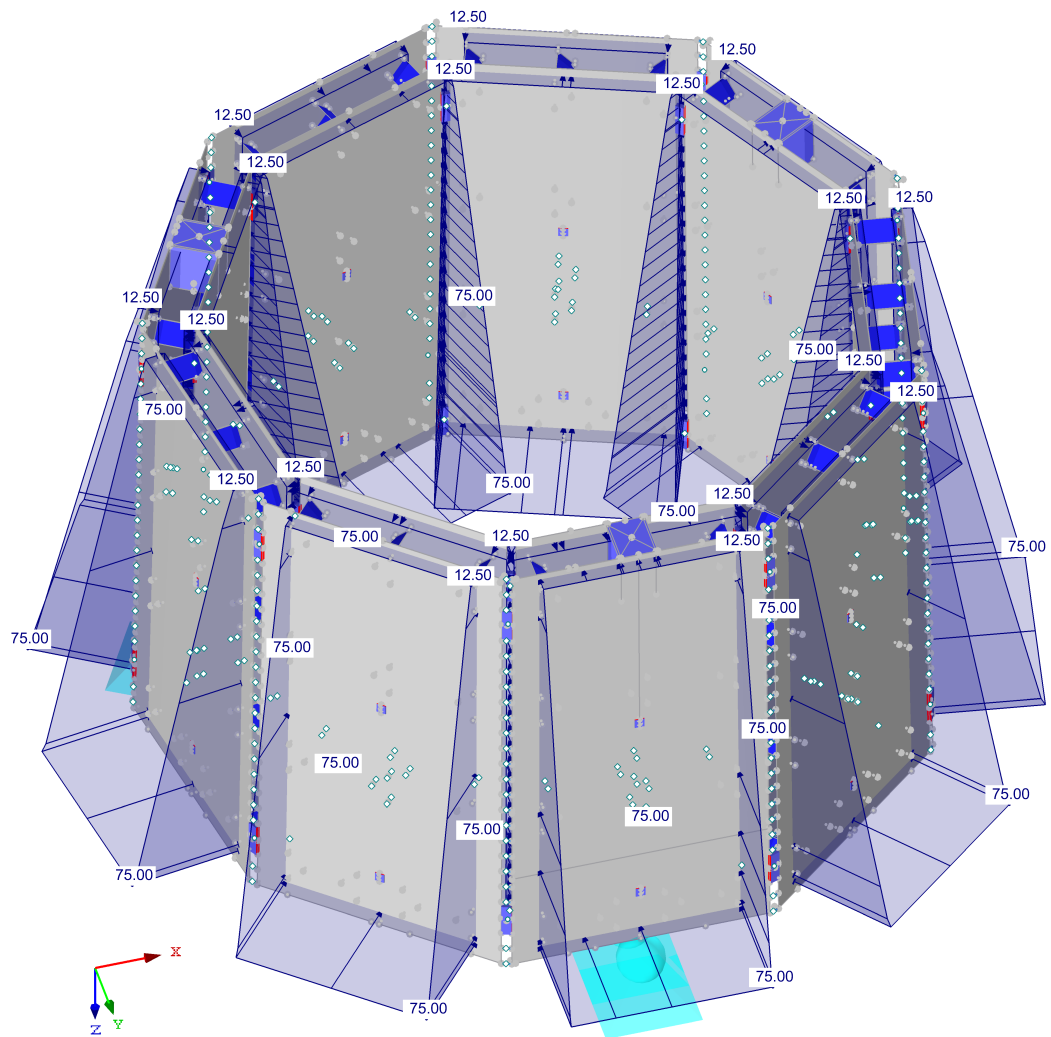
Lastfall Frischbetondruck - Druckverteilung für eine Betonierhöhe von 3,0 m auf ein 2,5 m hohes Segment
